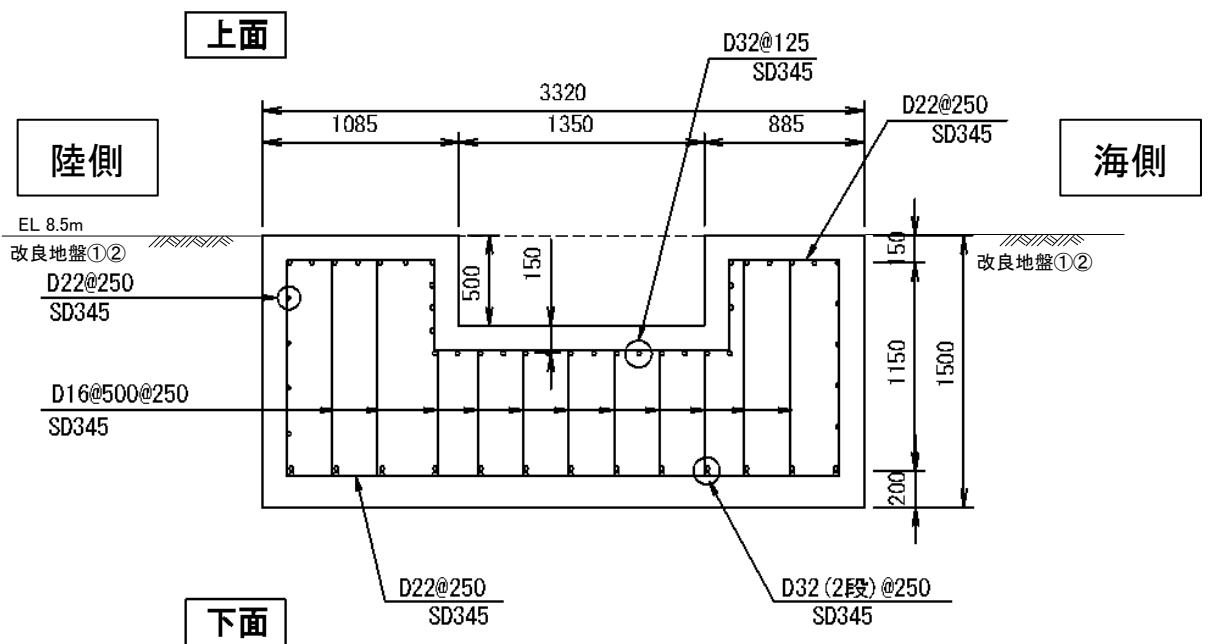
(2) 防波扉基礎スラブの概略配筋図
